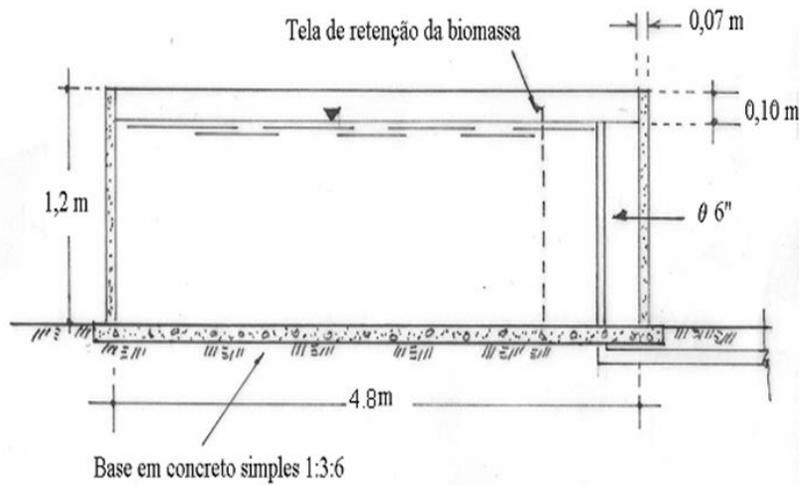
Vista lateral de tanque pré-moldado cilíndrico.
